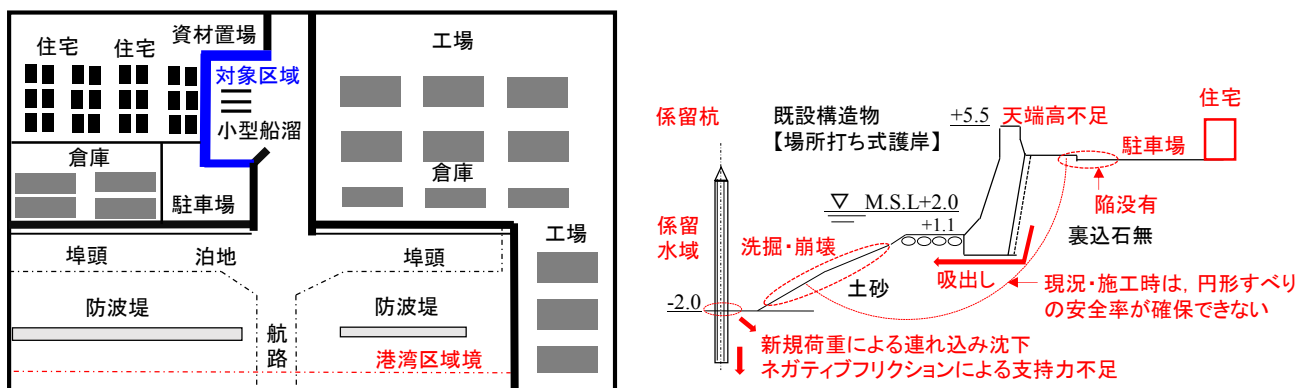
改良対象とした防潮護岸の平面位置図と断面図
